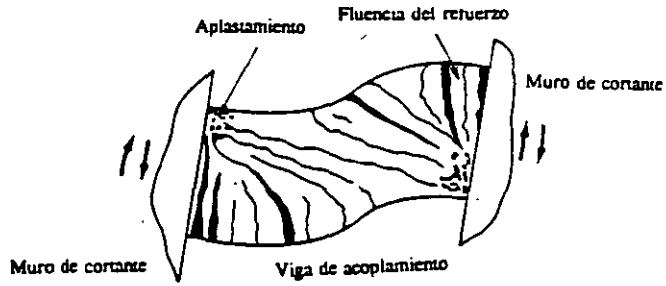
Deformación y agrietamiento de vigas de acoplamiento
